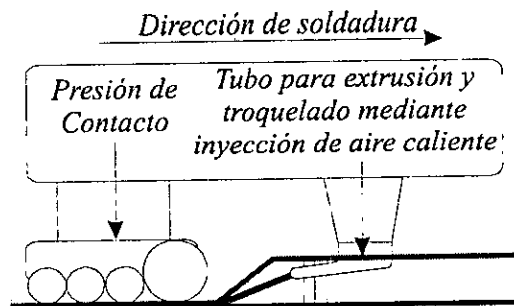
Soldadura de extrusión para unión en el sitio
